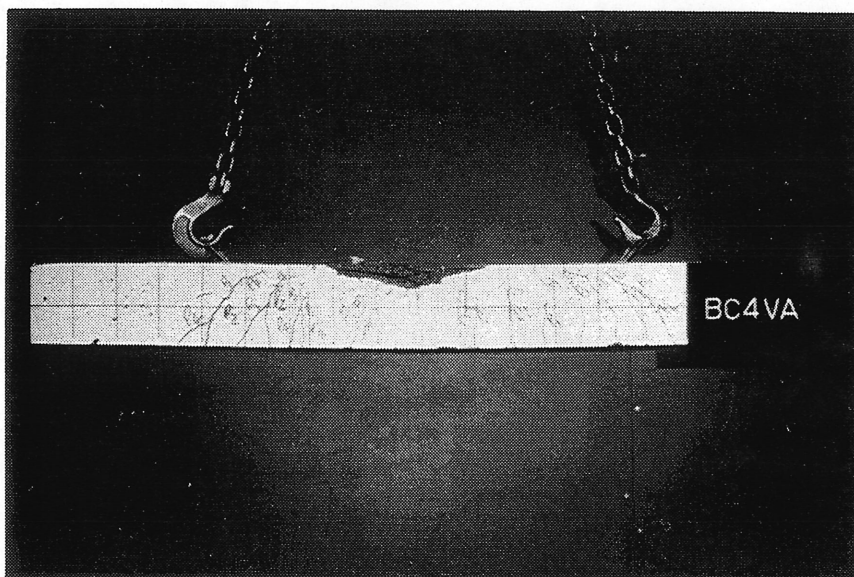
Rupture typique en compression (poutre BC4VA)
